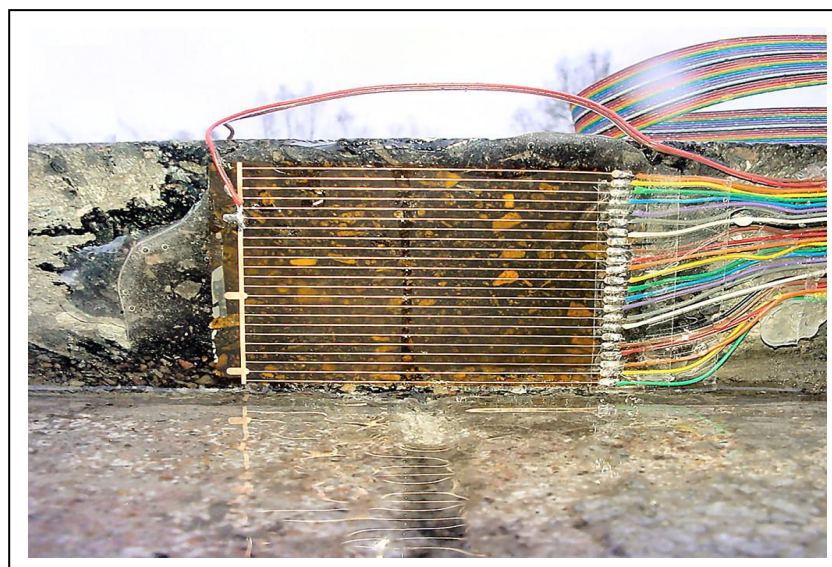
Jauges de fissurations type utilisées sur MEFISTO de 8 cm de longueur
